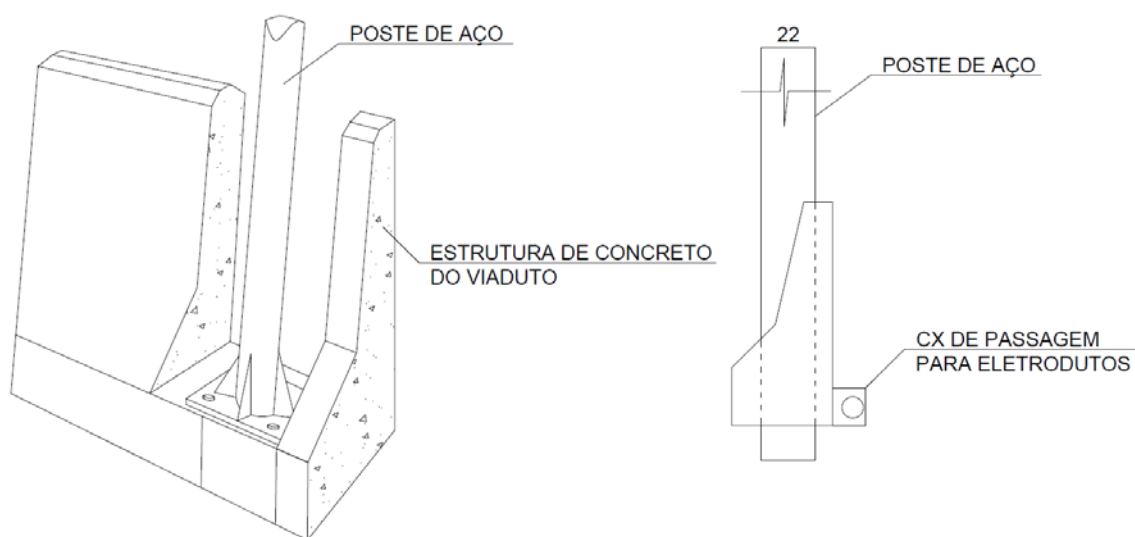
Fixação do poste flangeado entre barreiras New Jersey
